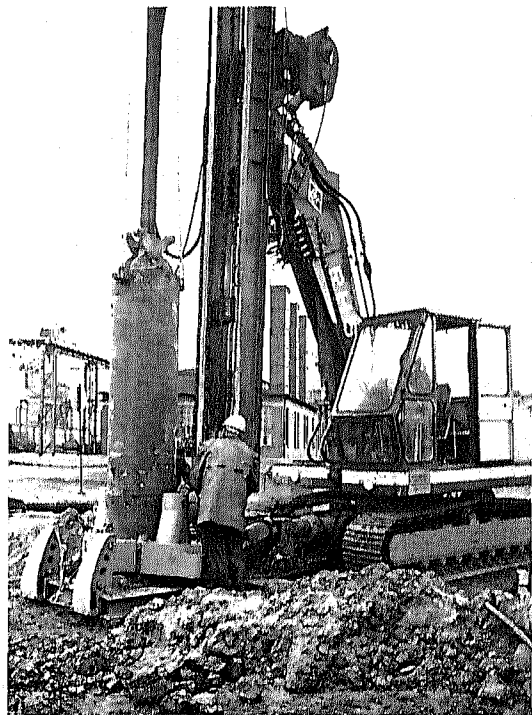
Verrohrungsmaschine VR 60 mit Baggeranbaubohrgerät BB 6 der Salzgitter Maschinen AG
